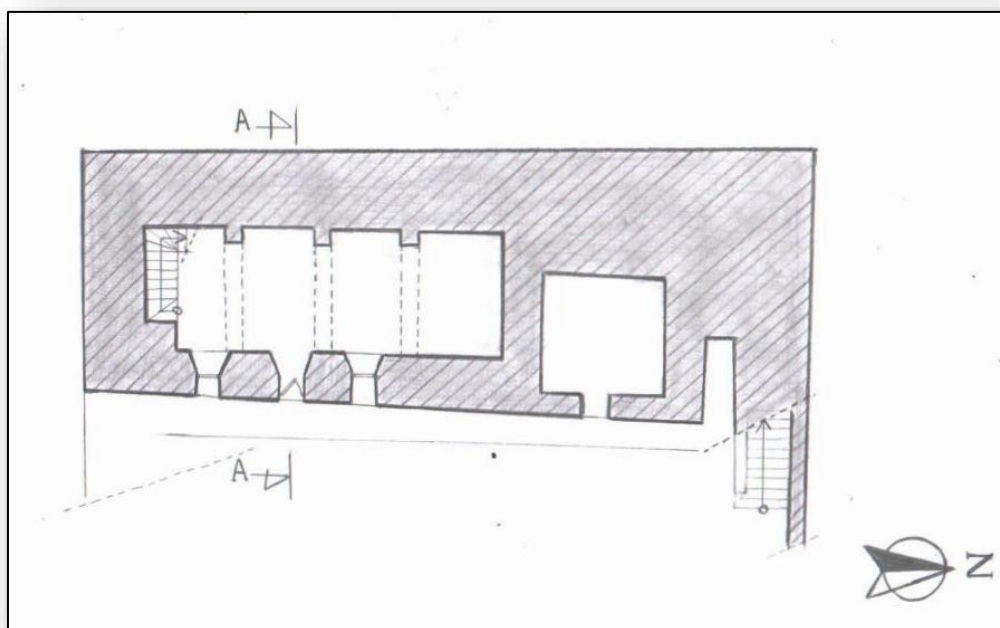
Vue En Plan Du 1^{er} Etage De La Prison.
